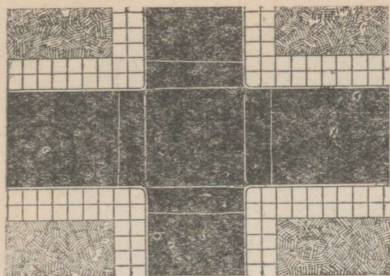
а. Четырехсторонний прямоугольный перекресток.
